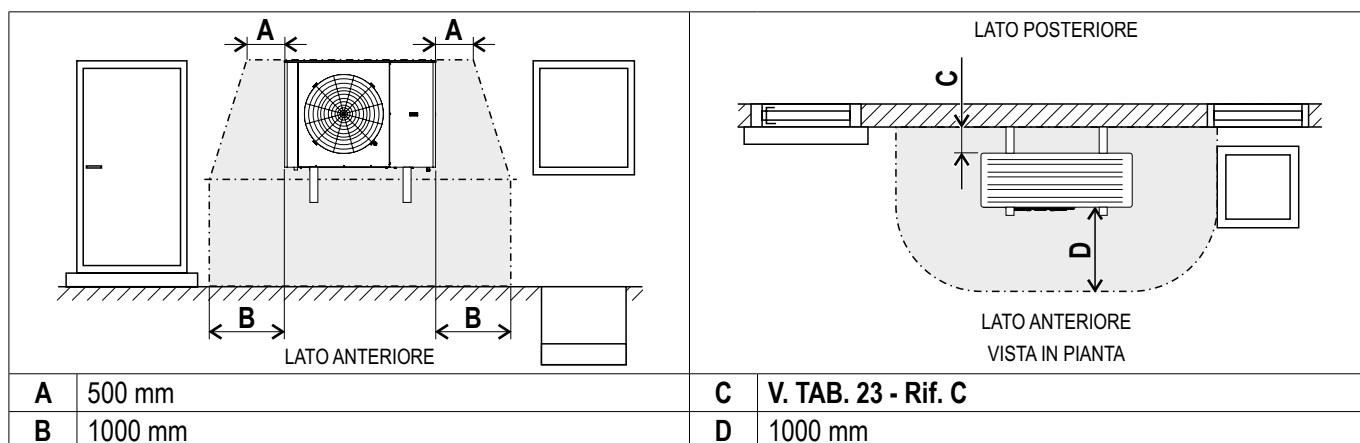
(Zona di sicurezza in caso di installazione a parete davanti a una parete dell'edificio)
